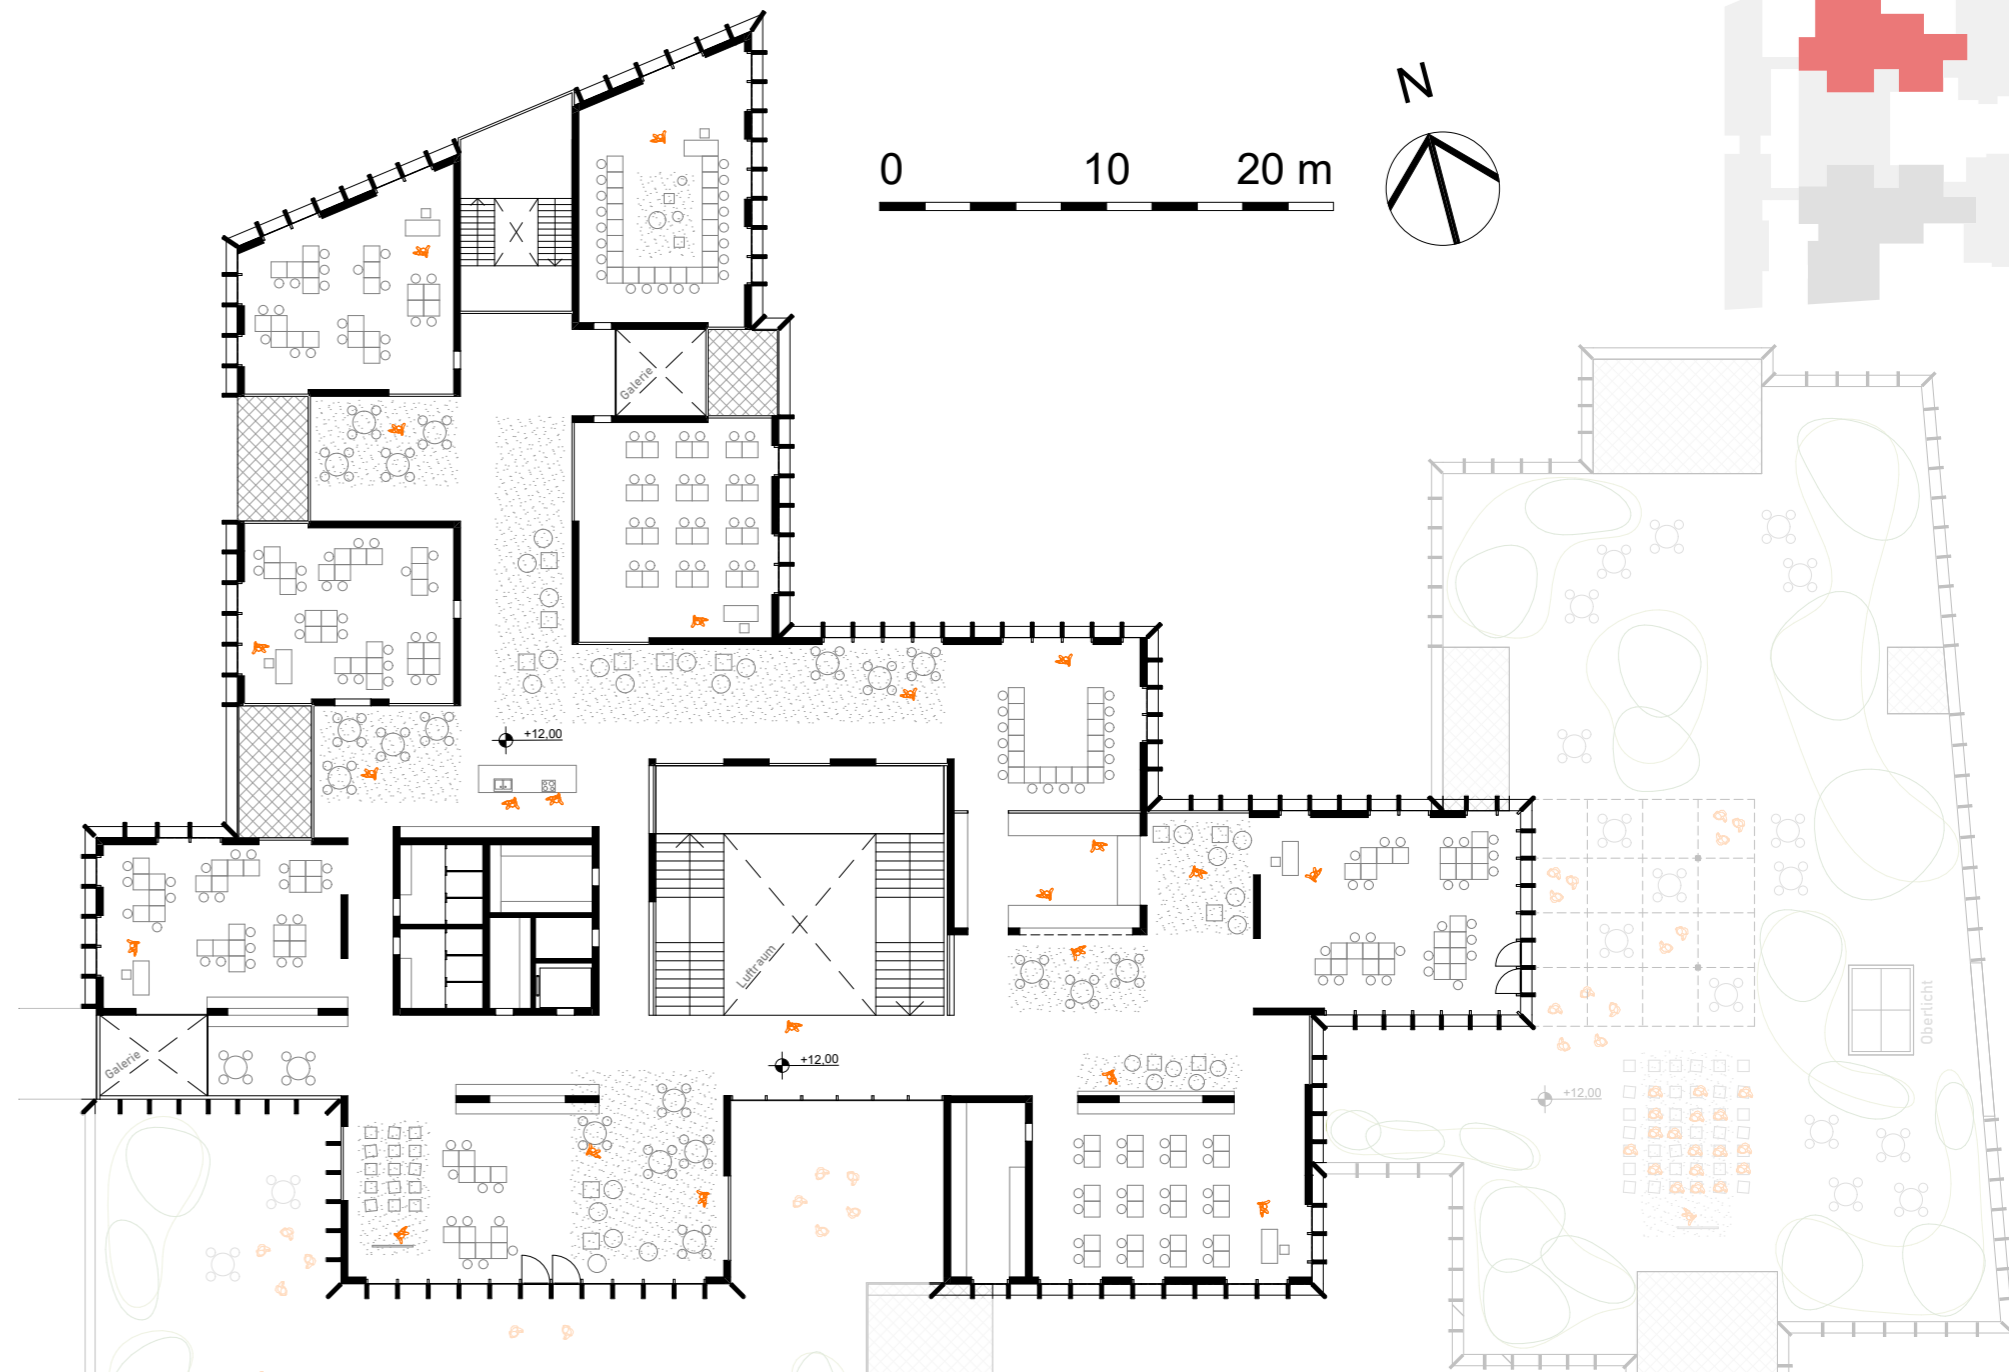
Grundriss Abschnitt-Cluster-Kreativbereich
